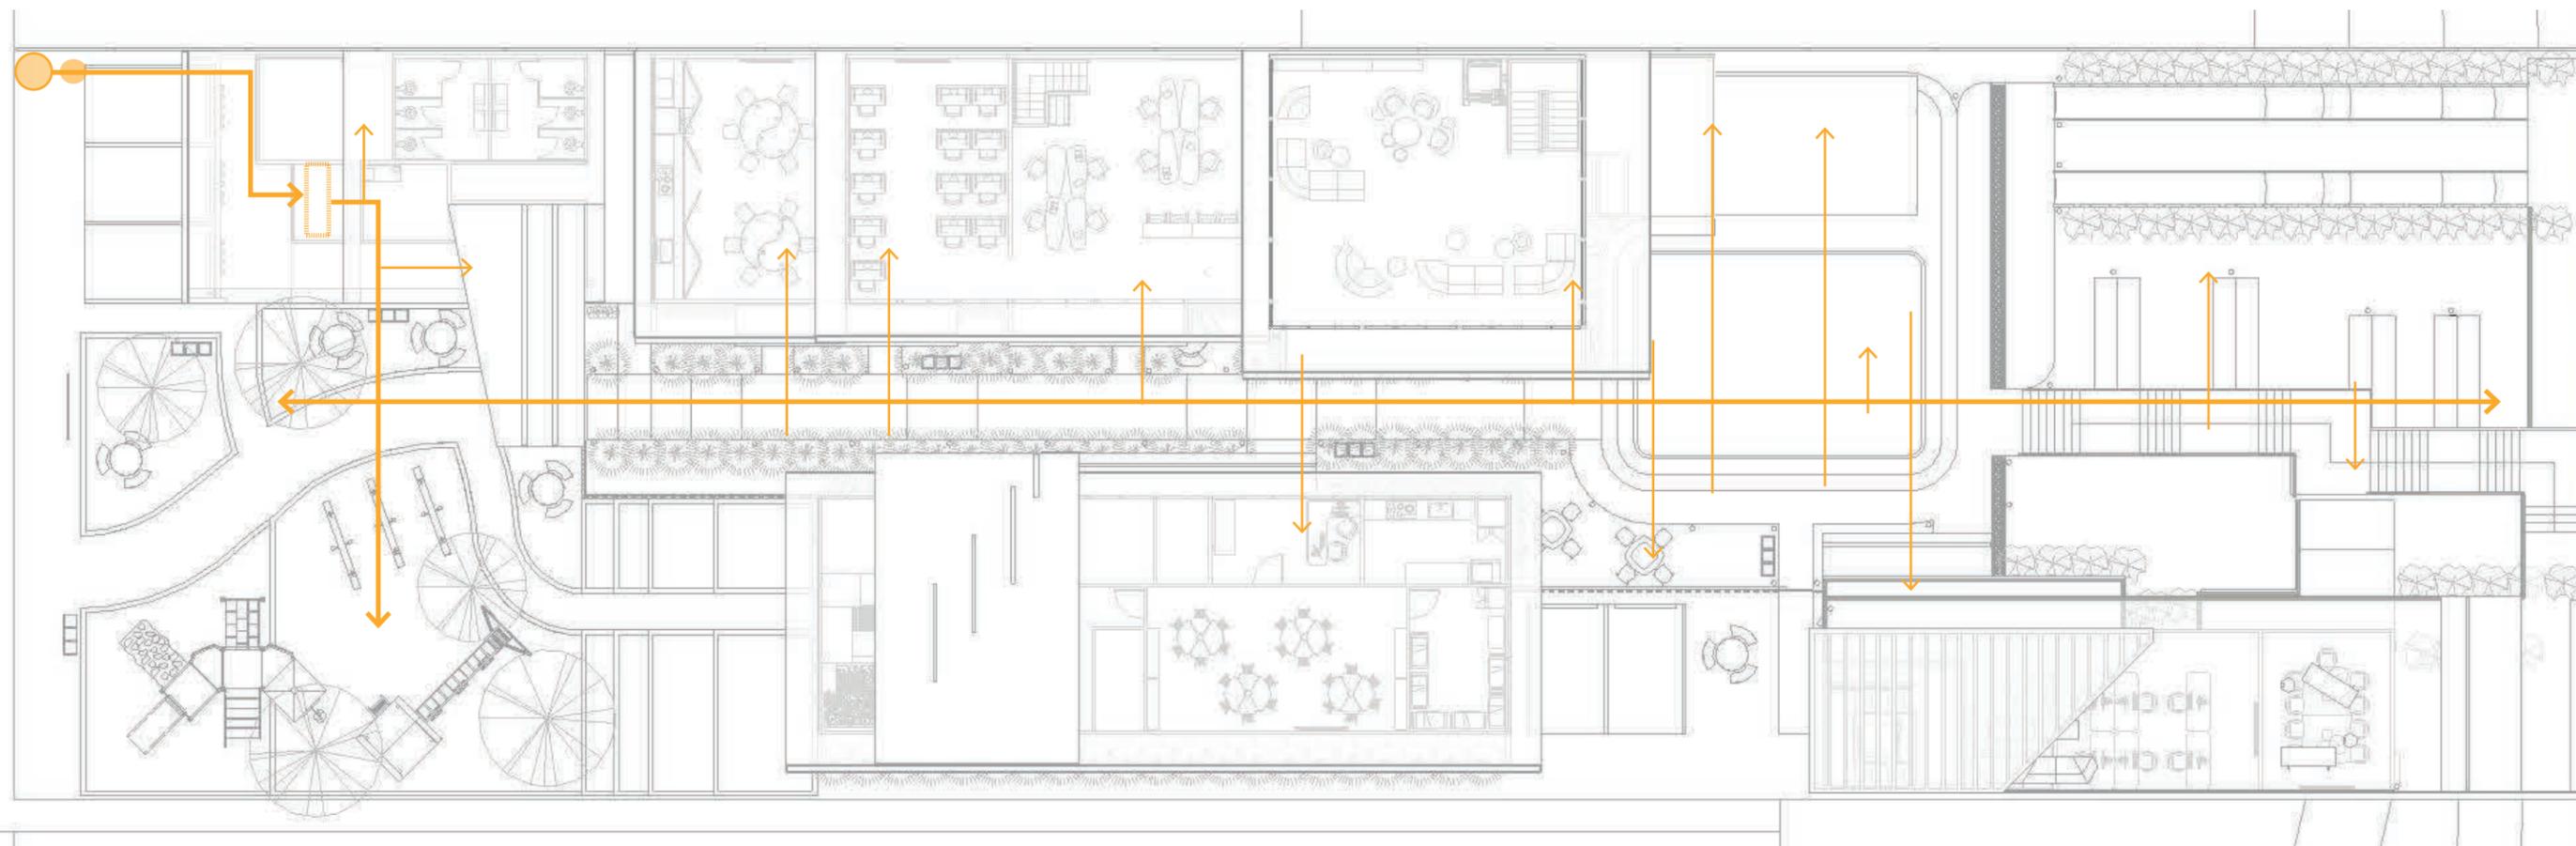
Planta ruta eléctrica. Fuente: Propia.
